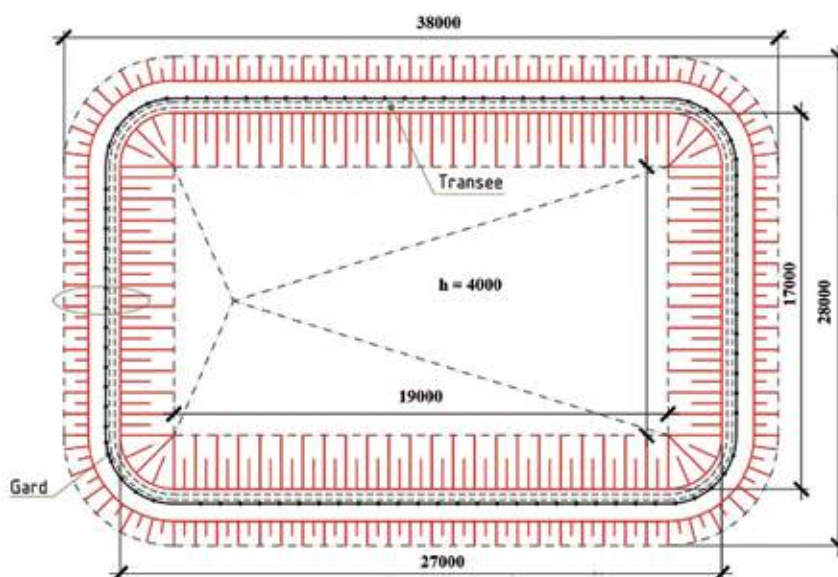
Schița plană a rezervorului batal pe bază de geomembrană
